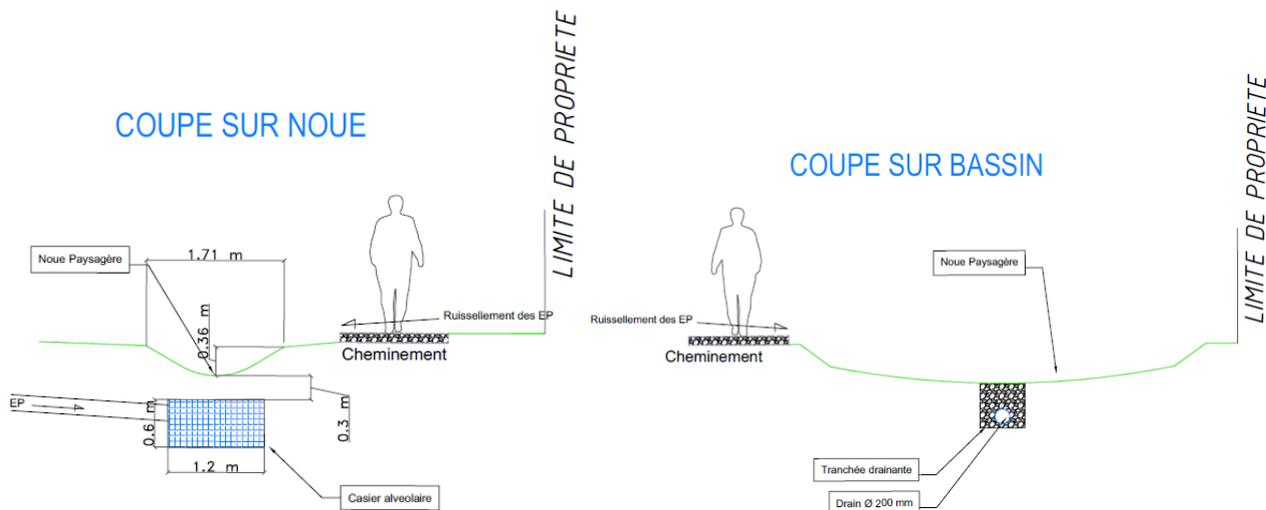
Système d'assainissement des eaux pluviales retenu (source : PITCH)
